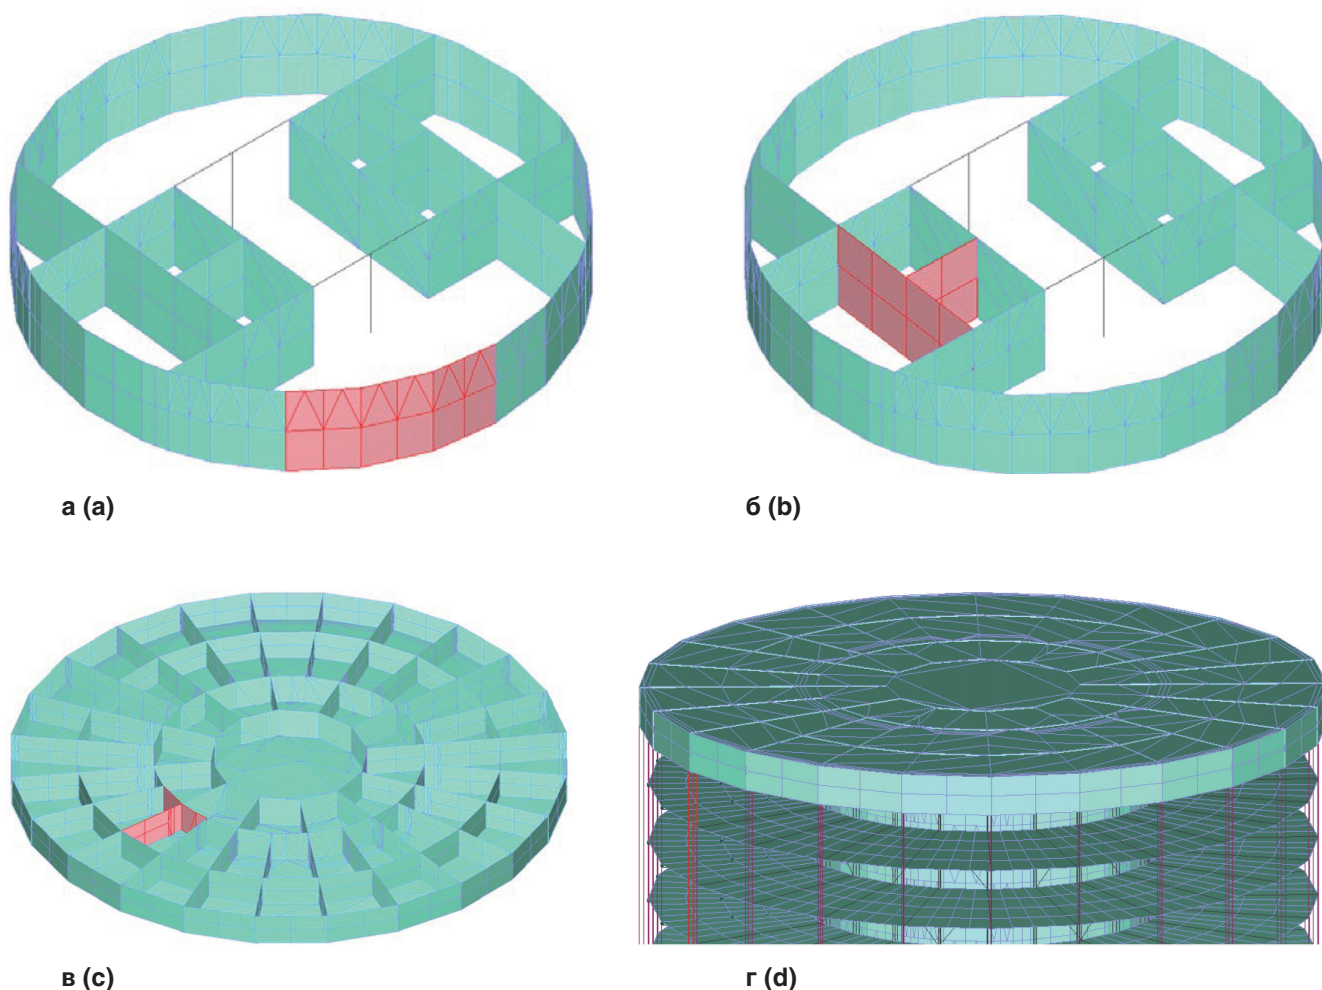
Сценарии локального разрушения несущих элементов: а – наружной стены ядра жесткости; б – внутренних стен ядра жесткости; в – балок консольного ростверка; г – наружных подвесок
